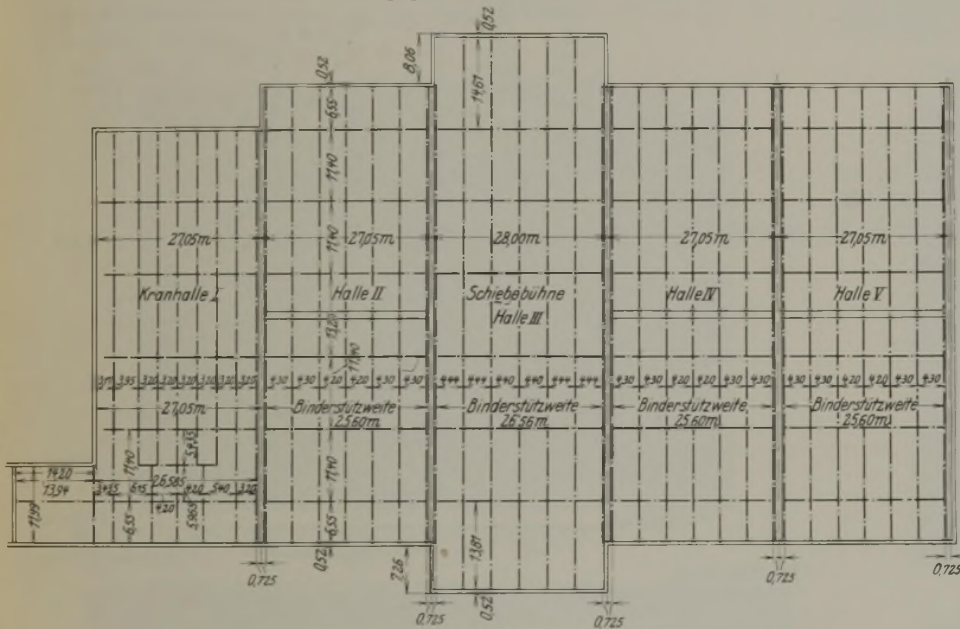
Holzdachkonstruktion des Lokomotivschuppens. Grundriß mit Binder- und Pfettenlage.
